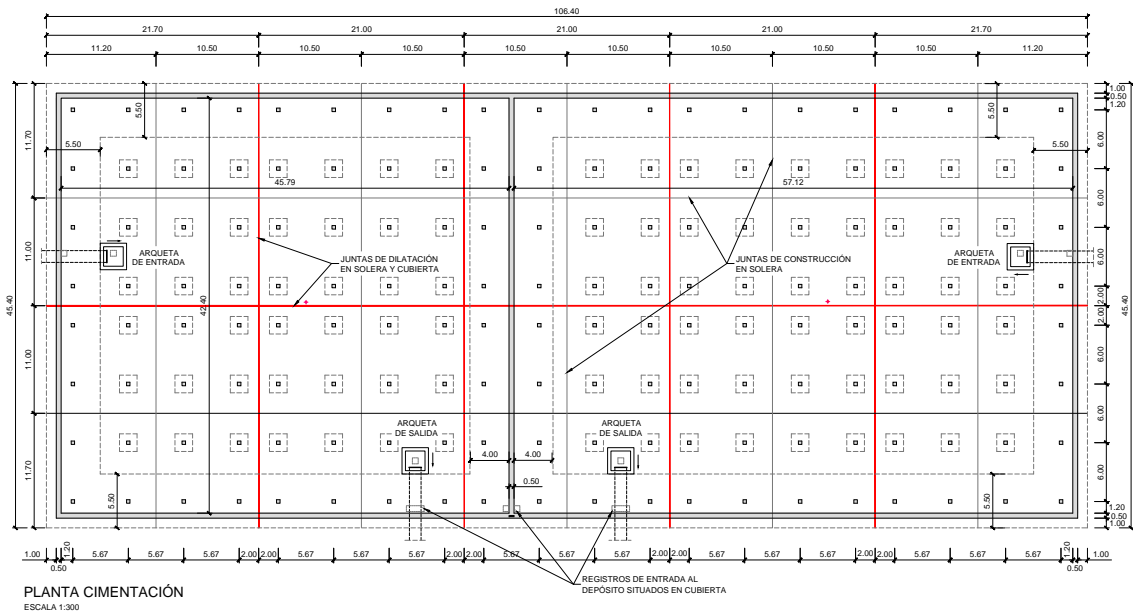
Plano 02.1 Planta del Estado Actual del depósito. Disponible en el doc. Nº 2. Planos.
